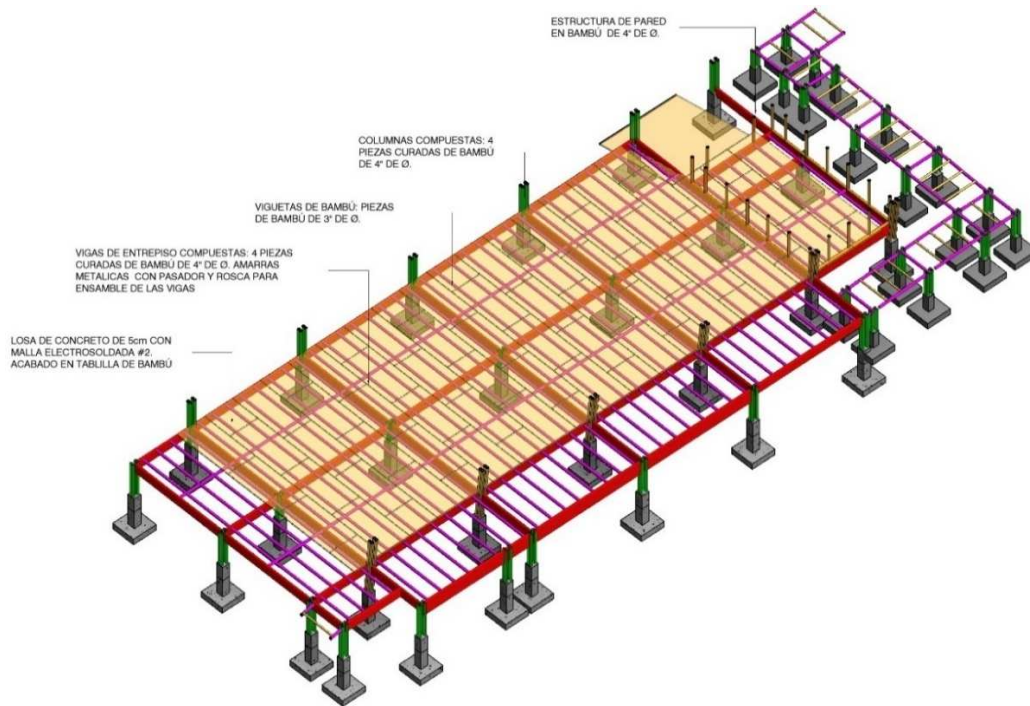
Esquema estructural de entresido en bambú. Fuente: Elaborada por el autor.
